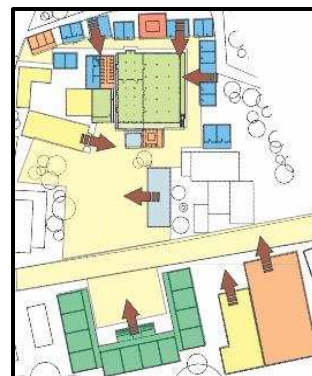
Hubungan Ruang Dalam Pondok Pesantren
